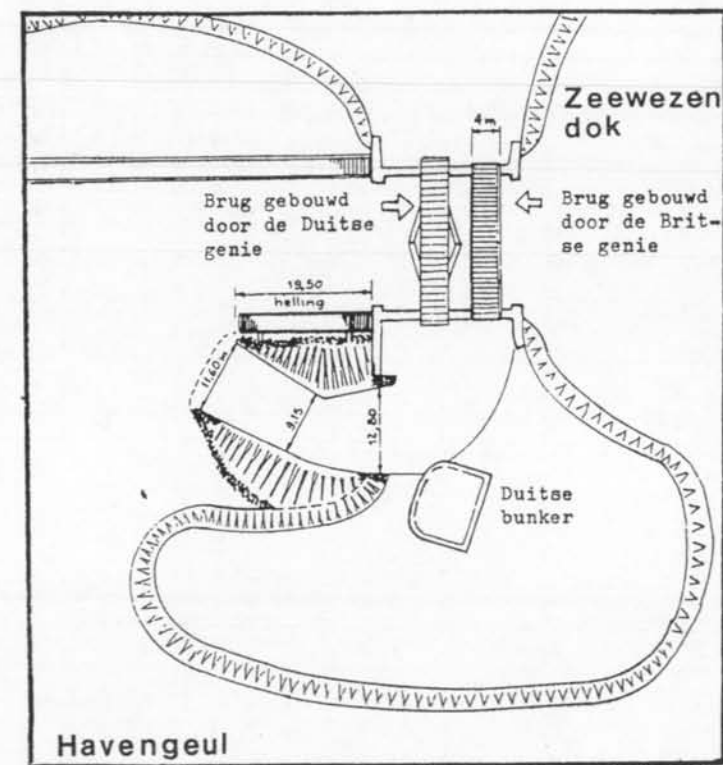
Oostende 1944, LST-helling nr. 1 (LST ramp no. 1). Inplanting, bovenaanzicht en langsdoorsnede van de door de Britten gebouwde landingsinstallatie tussen de beneden sluishoofden van de voormalige Visserijsluis. De helling bestaat ten heden dagen nog, (december 2005).
